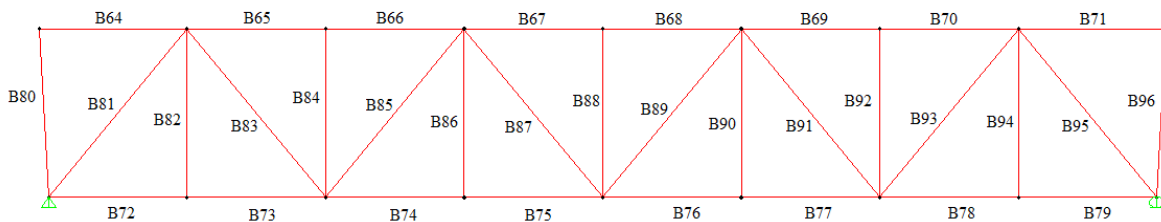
Vista en corte de la armadura en su lado A con numeración de elementos.
